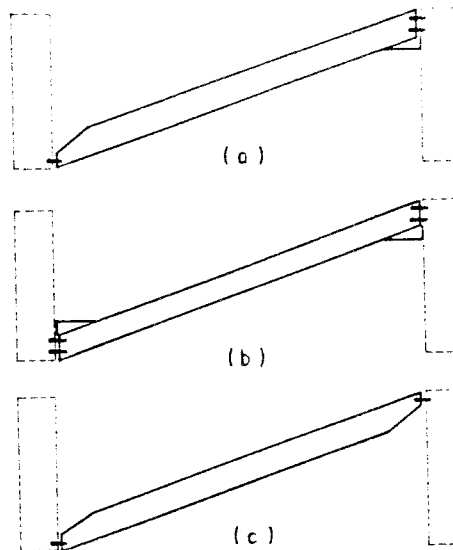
Apoios da trav de banzos paralelos ou alma cheia
